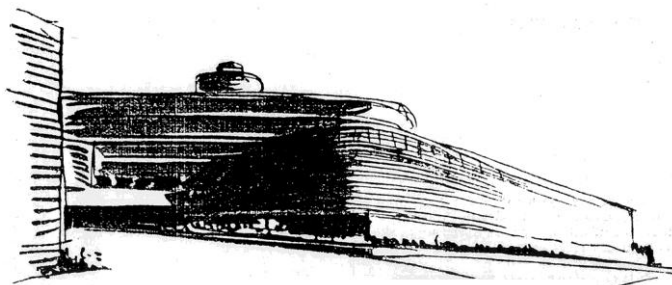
Alzado del proyecto (fachada Este, calle Serrano).
